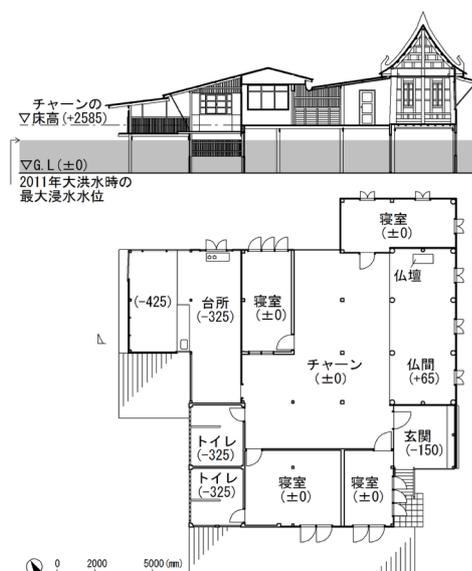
自然堤防集落の高床式住宅Aの平面図と断面図
